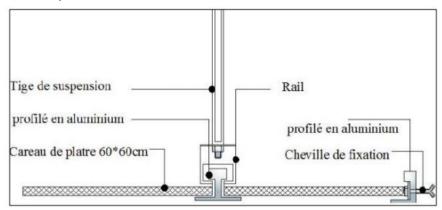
détail de fixation des faux plafond (coupe 1/20); source: http://www.knauf.ch/ fr/assortiment/plafonds/ systèmes/knauf-plattendecken.html
